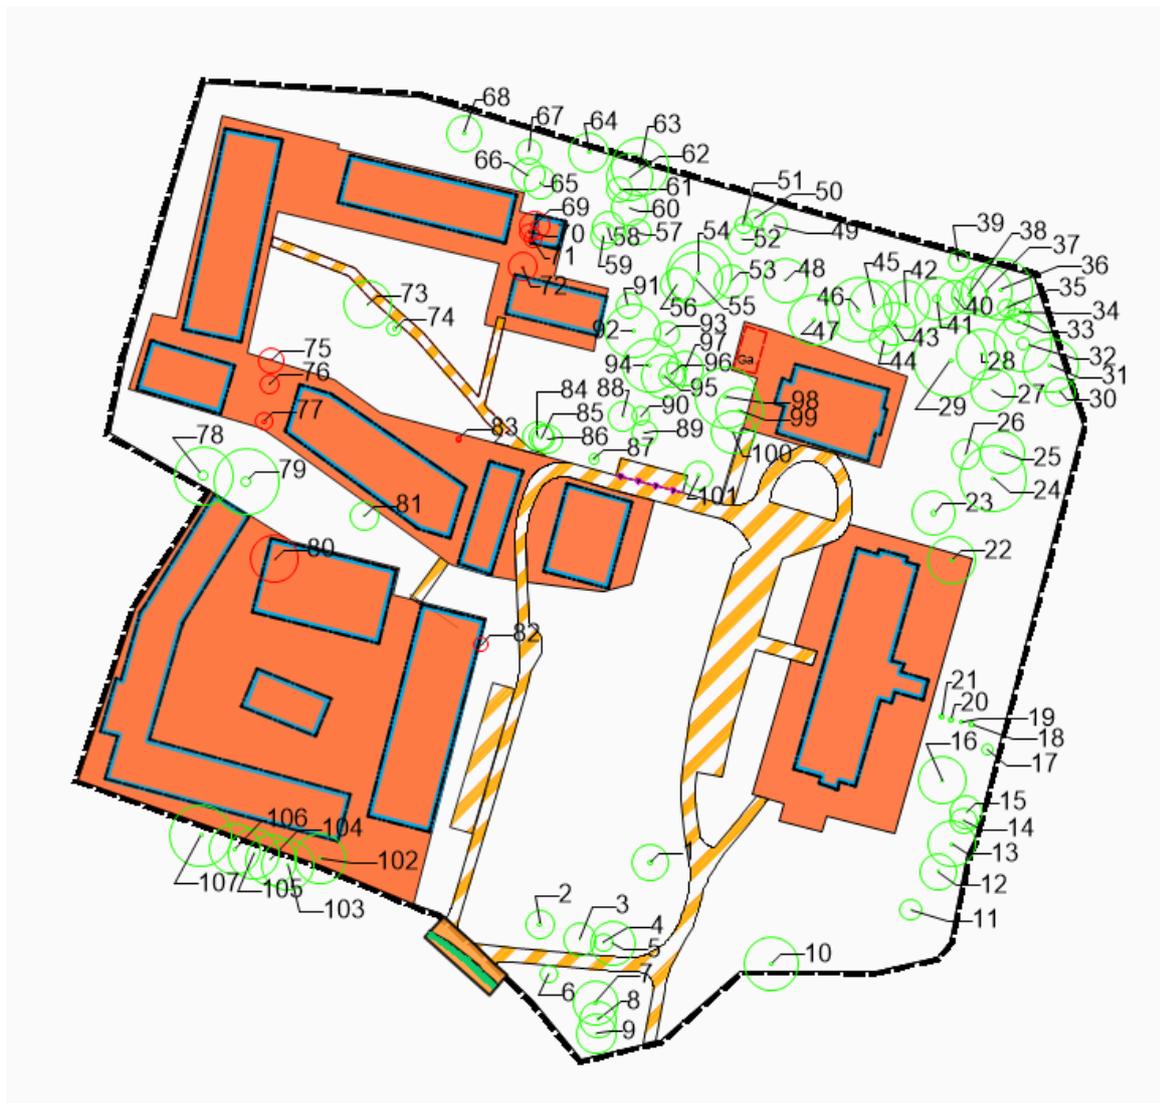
Baumbestand innerhalb des vorhabenrelevanten Bereichs mit Planung im Hintergrund, unmaßstäblich
